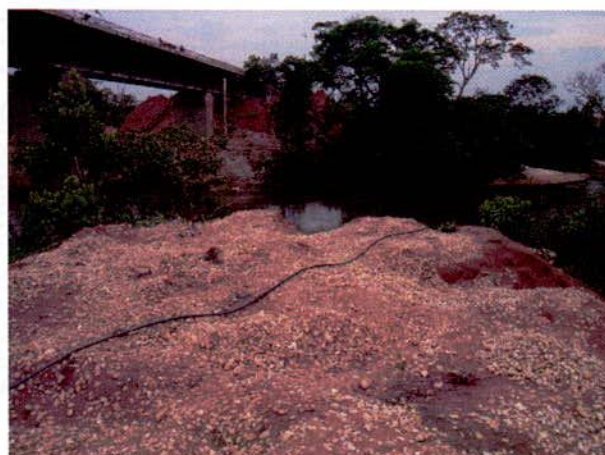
Solo oriundo da escavação dos pilares disposto irregularmente em APP.
